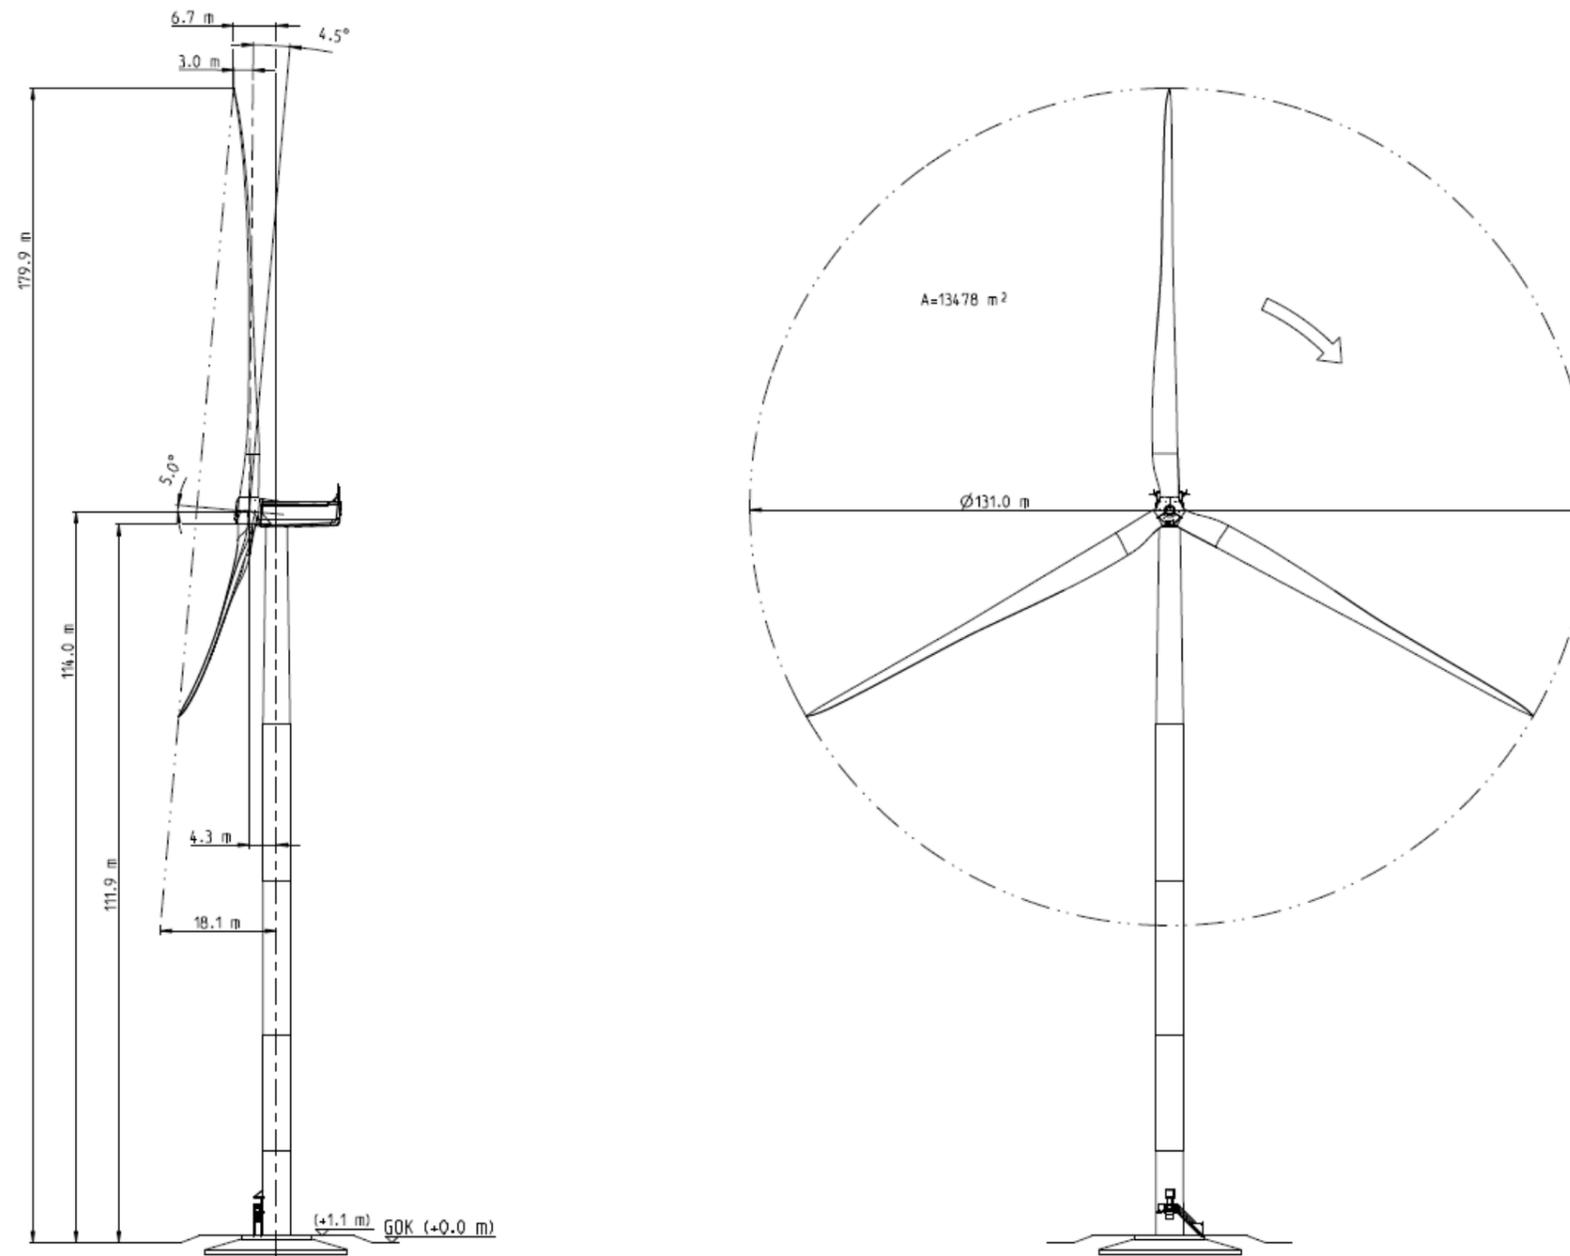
Plan d'élevation de l'éolienne N131 – 180m (Source : NORDEX)
